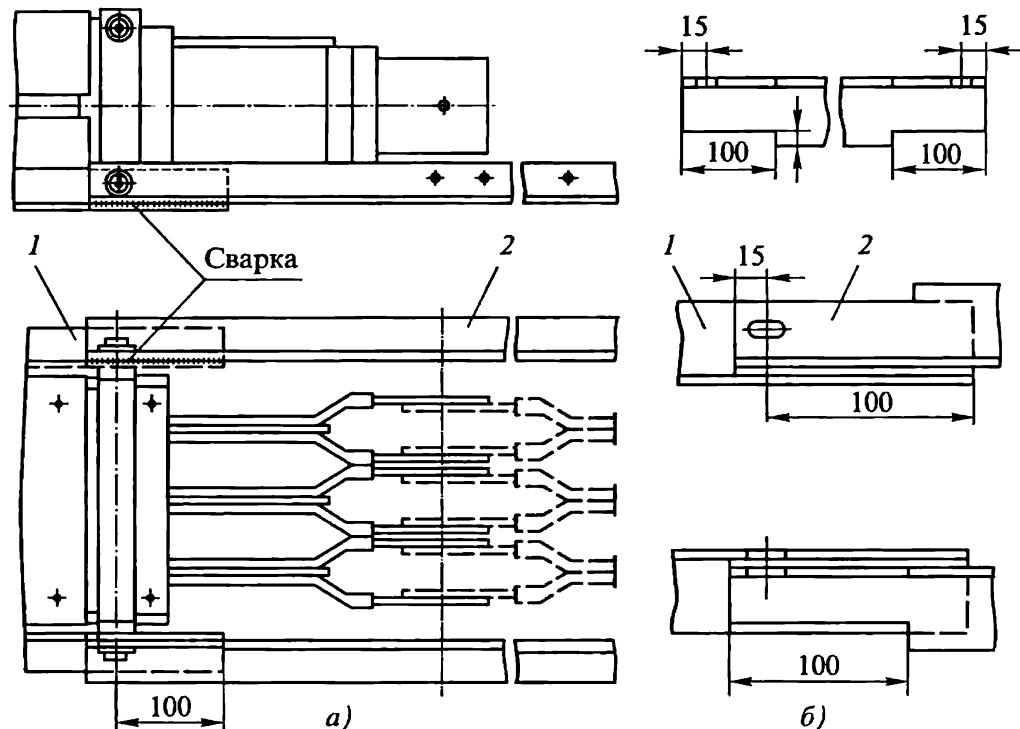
Схема подготовки опорных уголков шинопровода для сварки (а) и деталь (б) для вырезки полок опорного уголка и соединительной перемычки:
